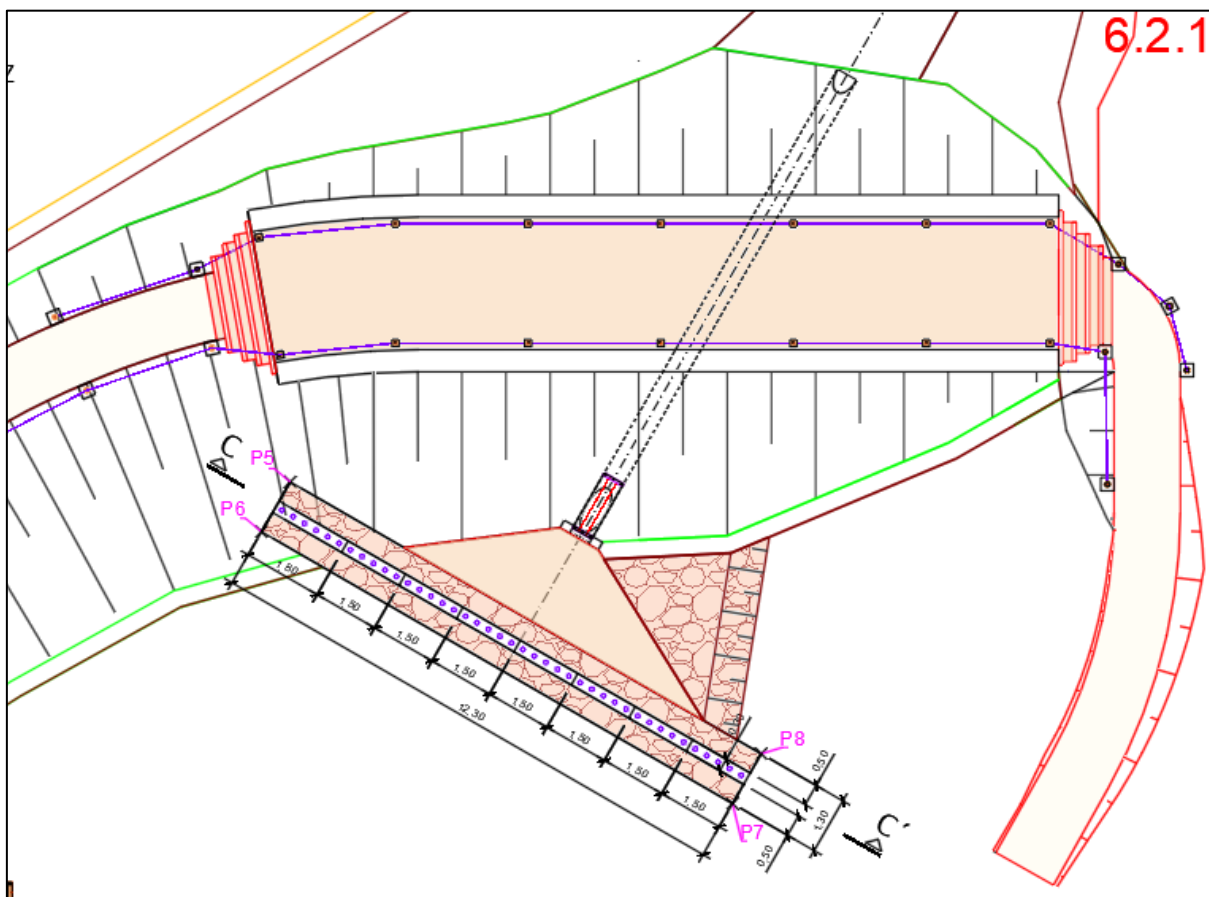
Croquis en planta del aliviadero y peine de desgaste.
